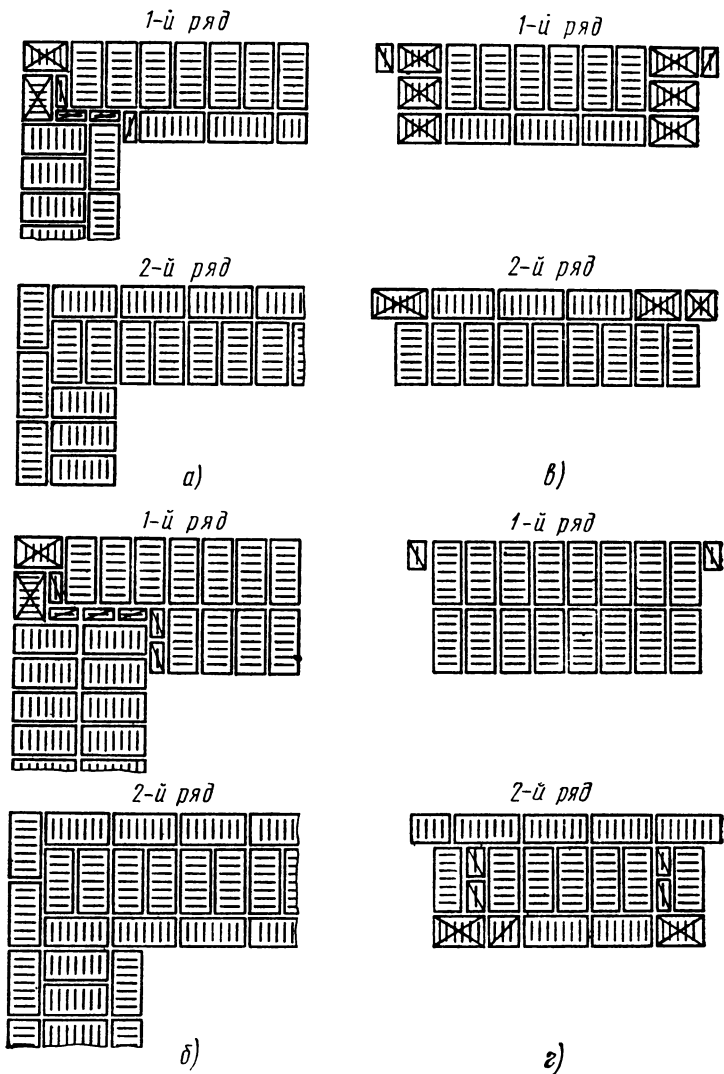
Порядовая кладка из керамических пустотелых камней углов стен (а, б) и простенков (в, г):
